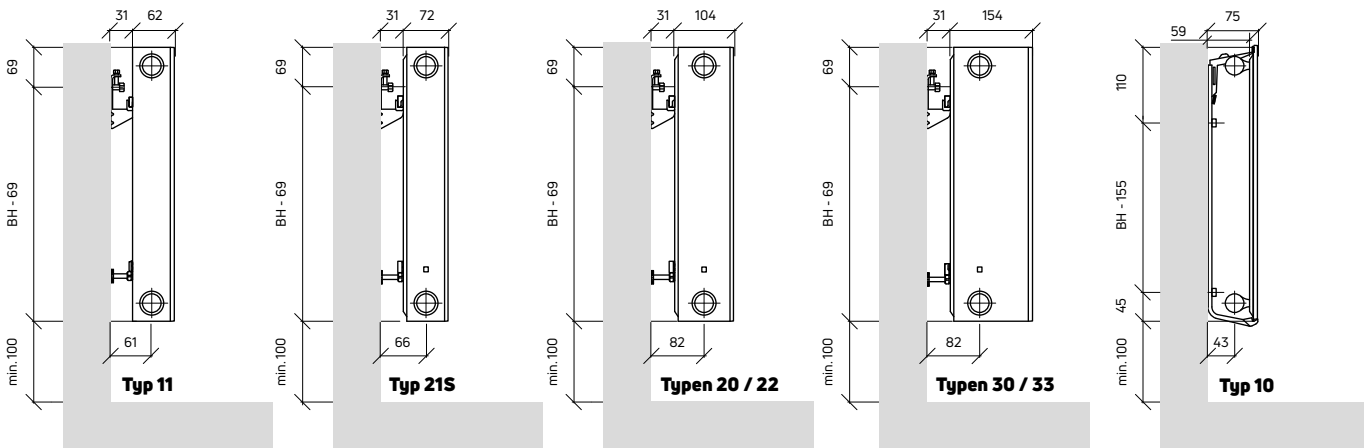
Montagemaße für Plan Compact und Ramo Compact mit Befestigungslaschen
